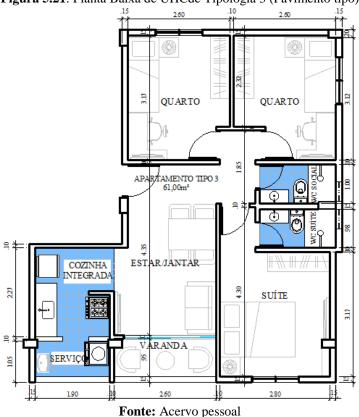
Planta Baixa de UHCde Tipologia 3 (Pavimento tipo)
